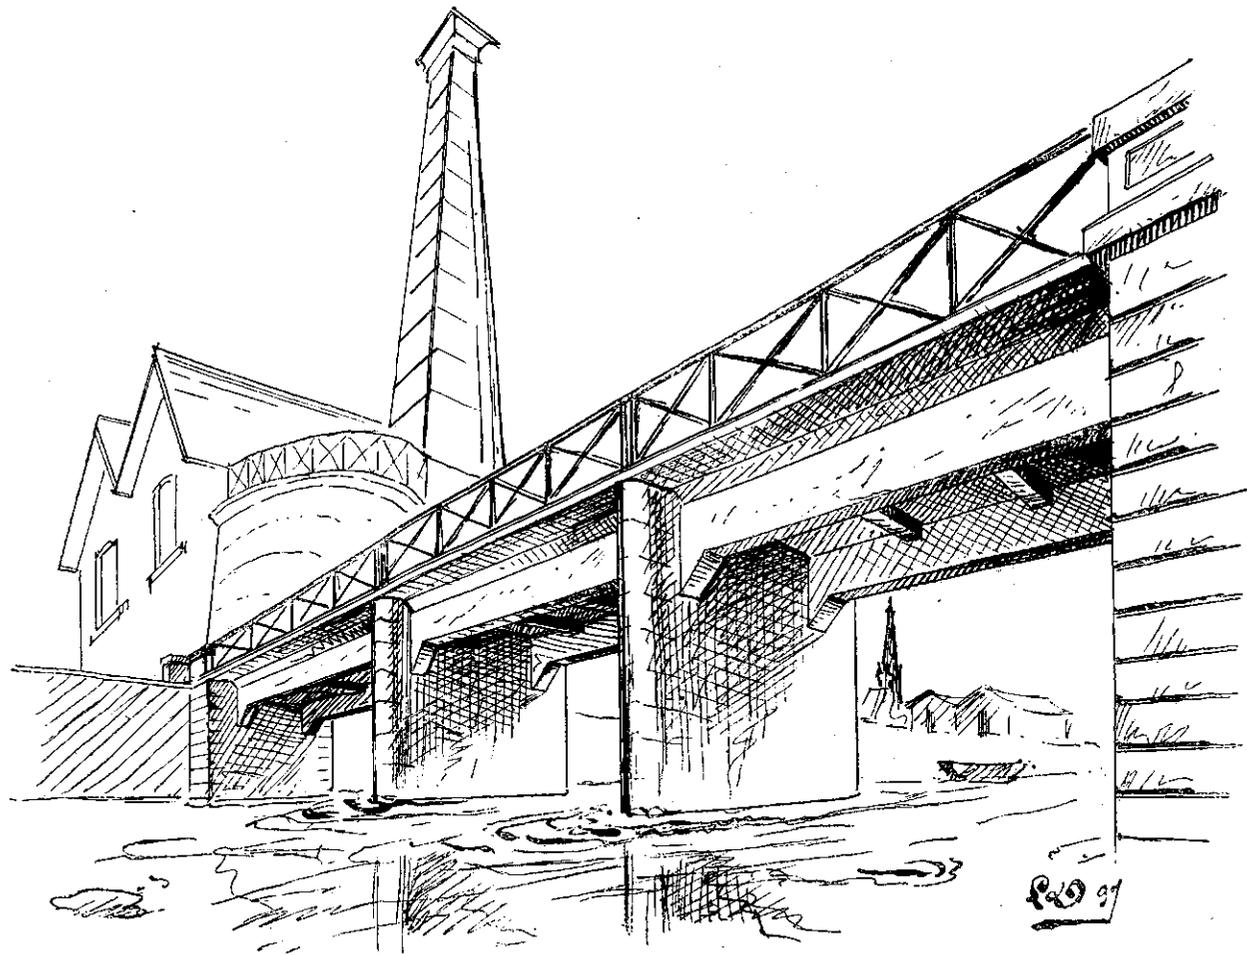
Le pont de Vif, sur la Gresse, en béton de ciment armé (syst. Hennebique).
